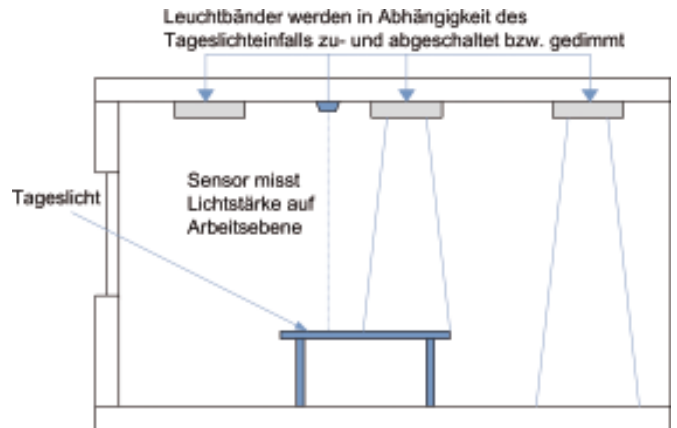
Prinzip der tageslichtabhängigen Beleuchtungssteuerung [31]
